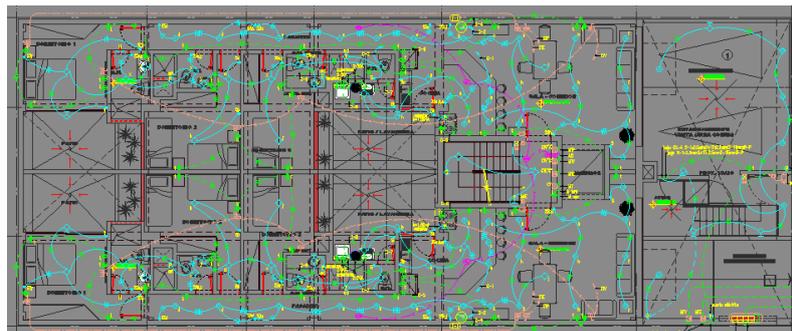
Plano Instalaciones Eléctricas 2D edificio Spuknit - Surco
